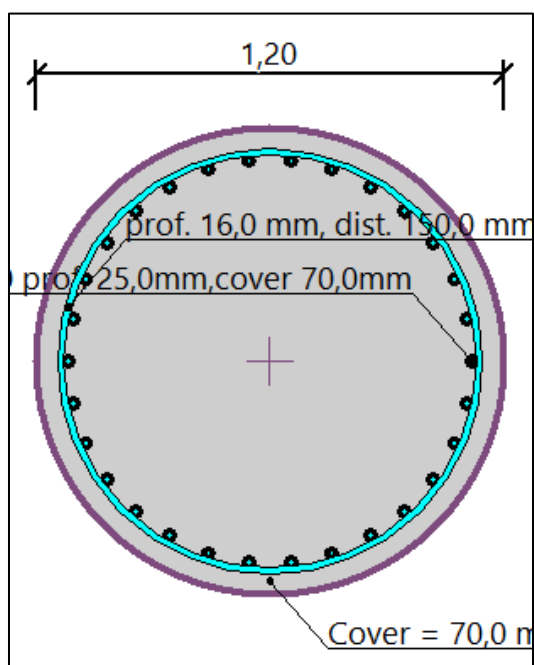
Schéma de ferrailage longitudinal d'une rangée de pieux.
